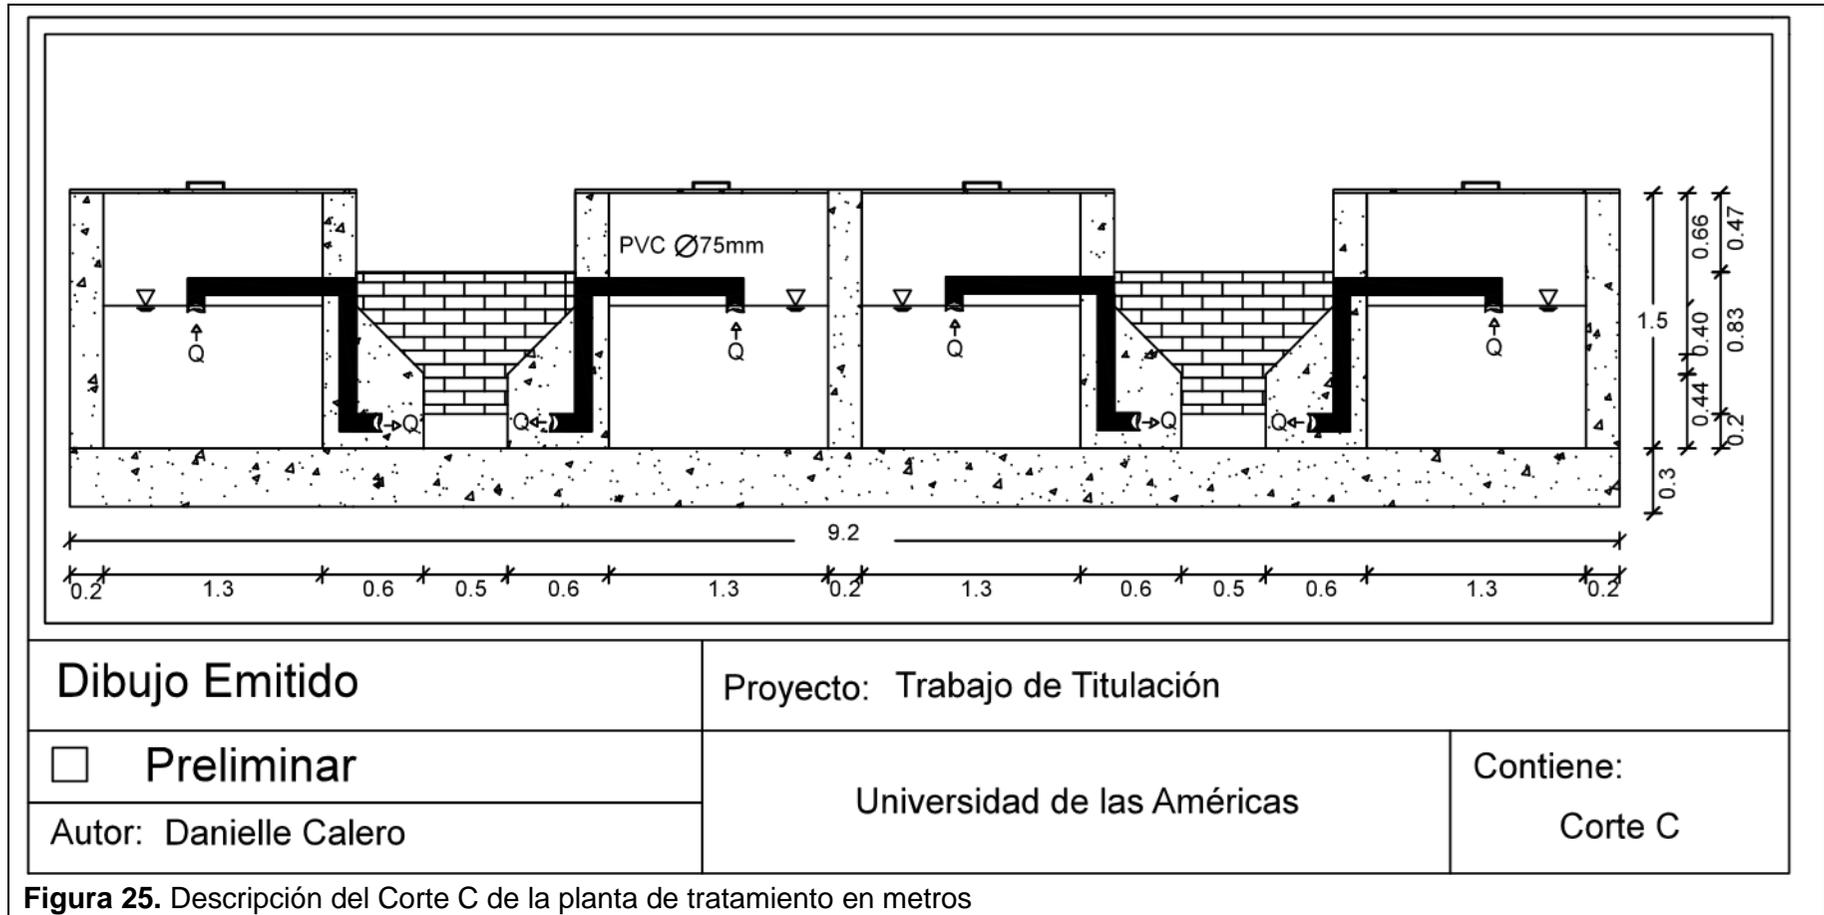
Descripción del Corte C de la planta de tratamiento en metros
